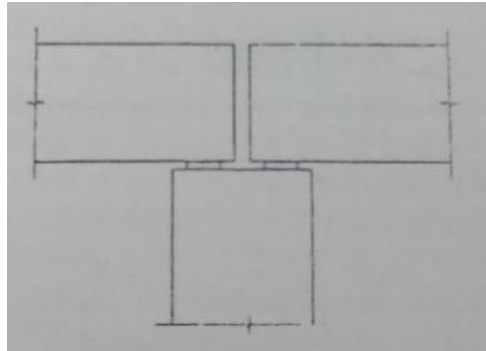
Junta de dilatación de pilar único y apoyos deslizantes. (elaboración propia)
